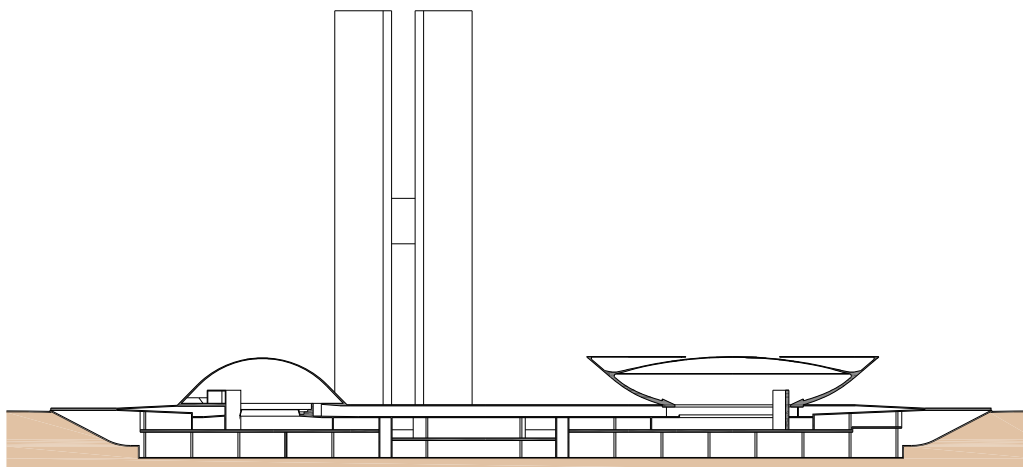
Projeto Executado – Corte Longitudinal. 2008.
